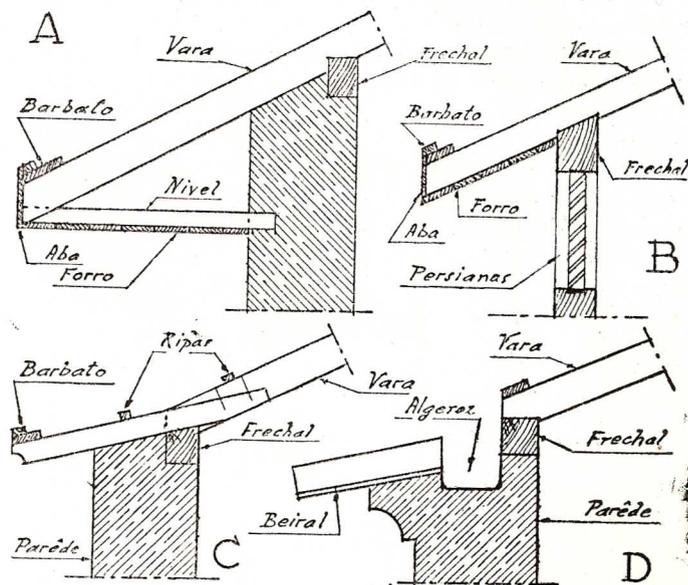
ESTRUTURAS PARA BEIRAIS
